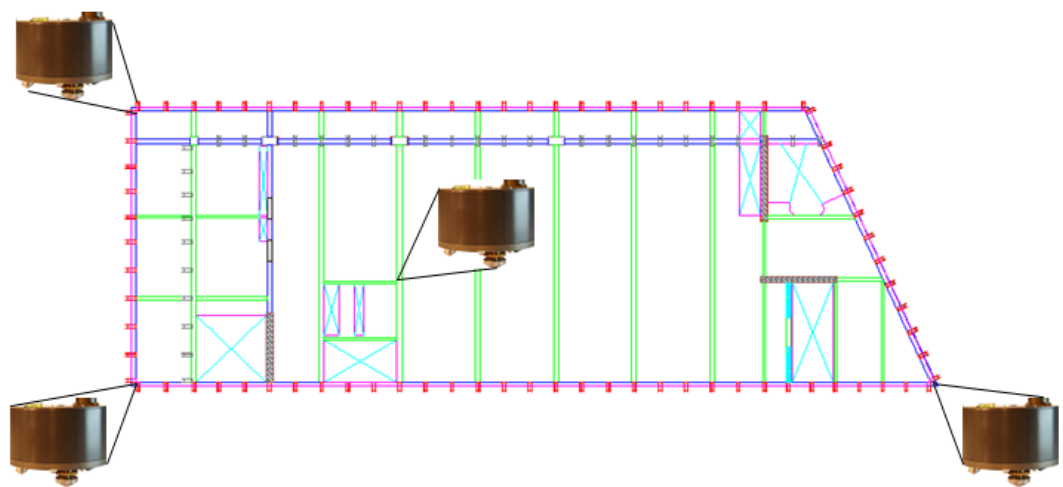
Ubicación de los acelerómetros en las plantas 4, 8 y 14
